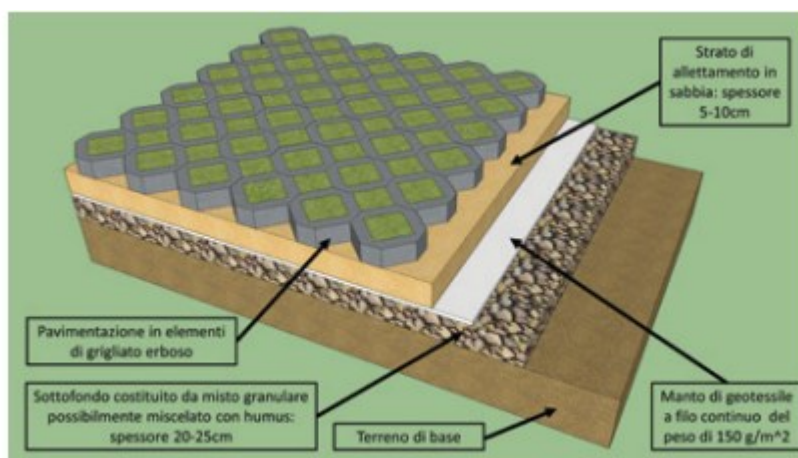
Stratigrafia pavimentazione permeabile.(Tratto da:
